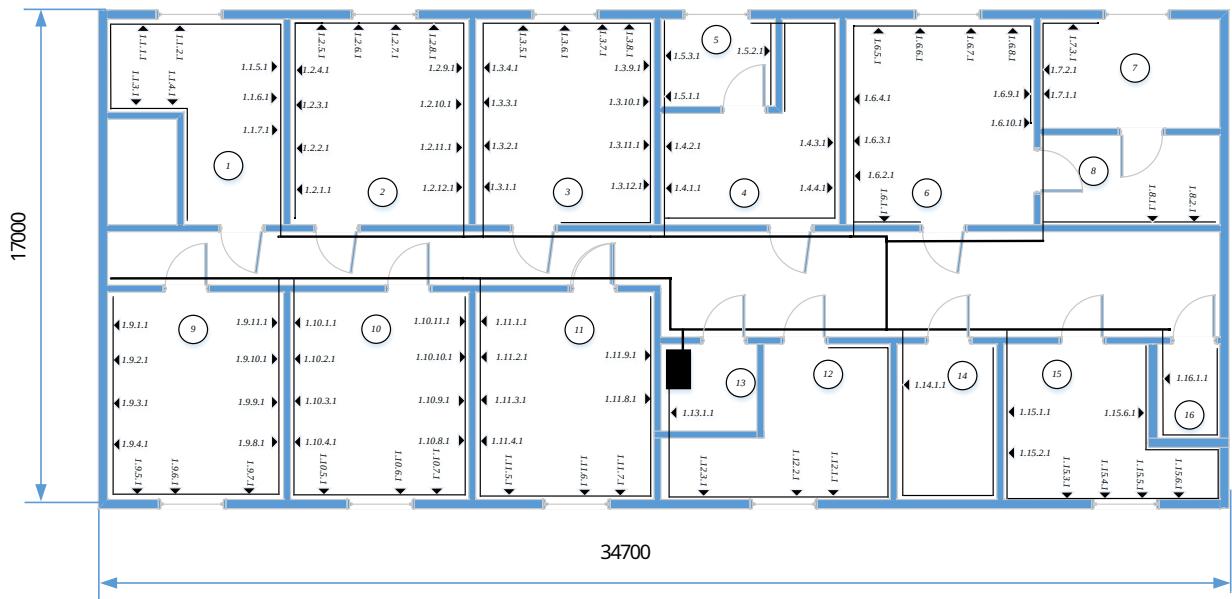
План размещения рабочих мест на 1-ом этаже
